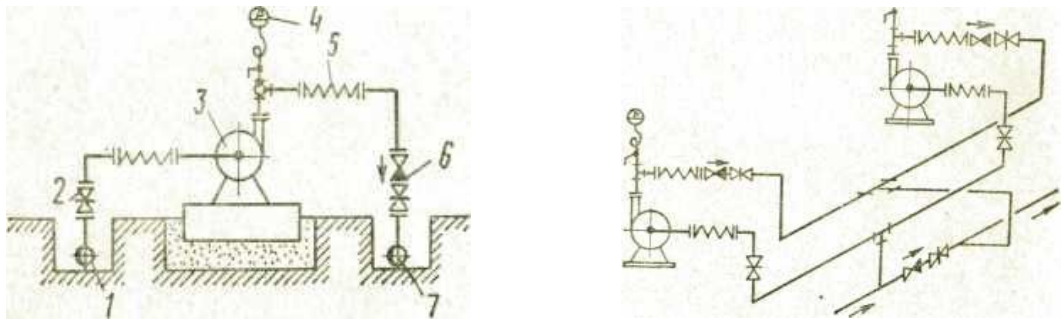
Схеми обв'язування насосів трубопроводами
